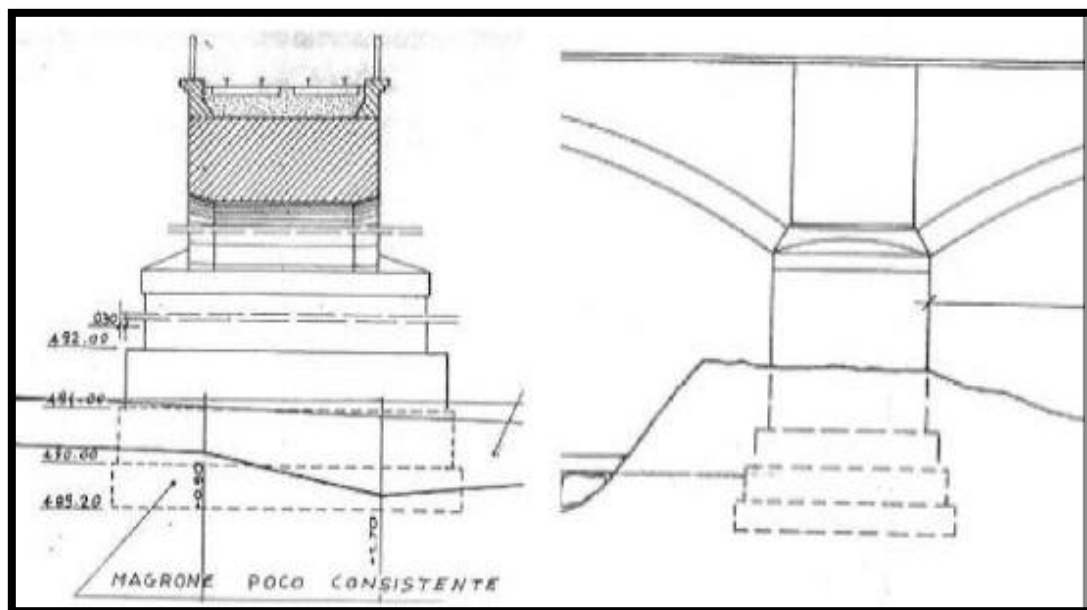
Fondazione superficiale. (Fonte:RABIOLI,R 1993).
